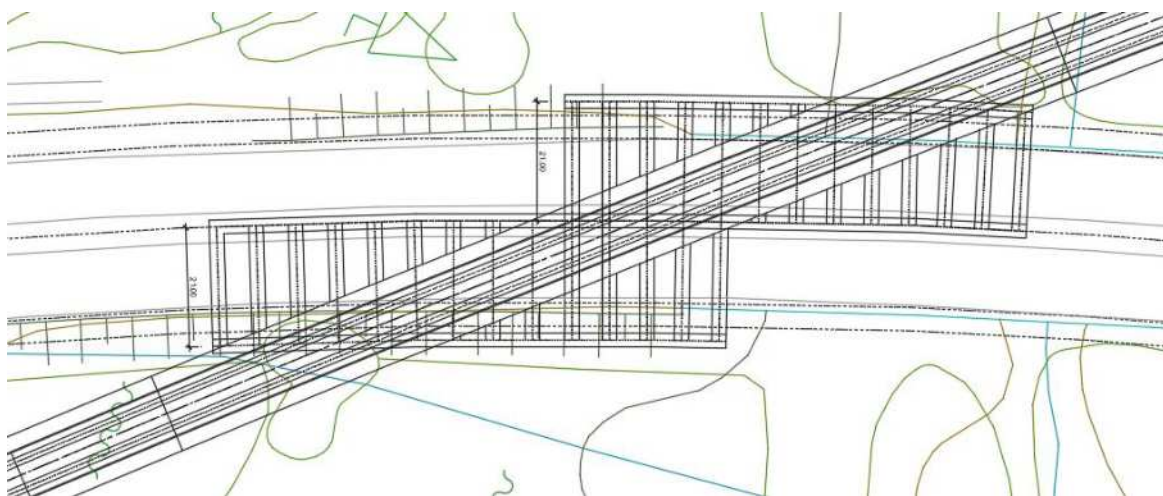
Vista em planta da solução esquemática do “fly over” sobre a A1 e alçado
